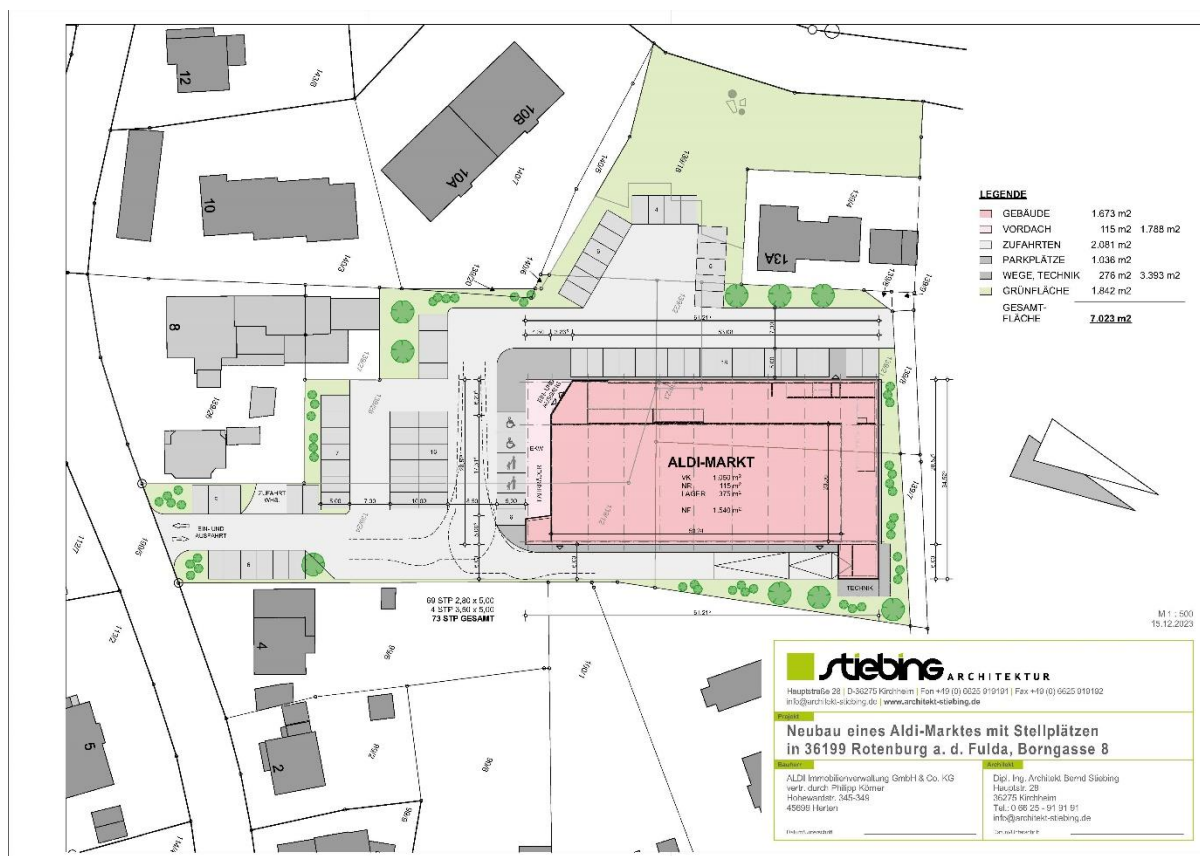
Lageplan Neuplanung ALDI-Markt – ohne Maßstab (Quelle: Stiebing Architektur)
